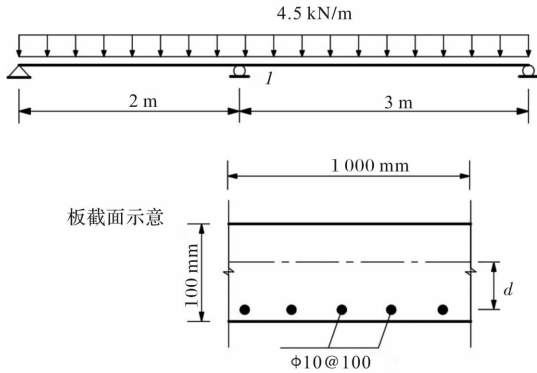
钢筋混凝土两跨连续单向板配筋及荷载
